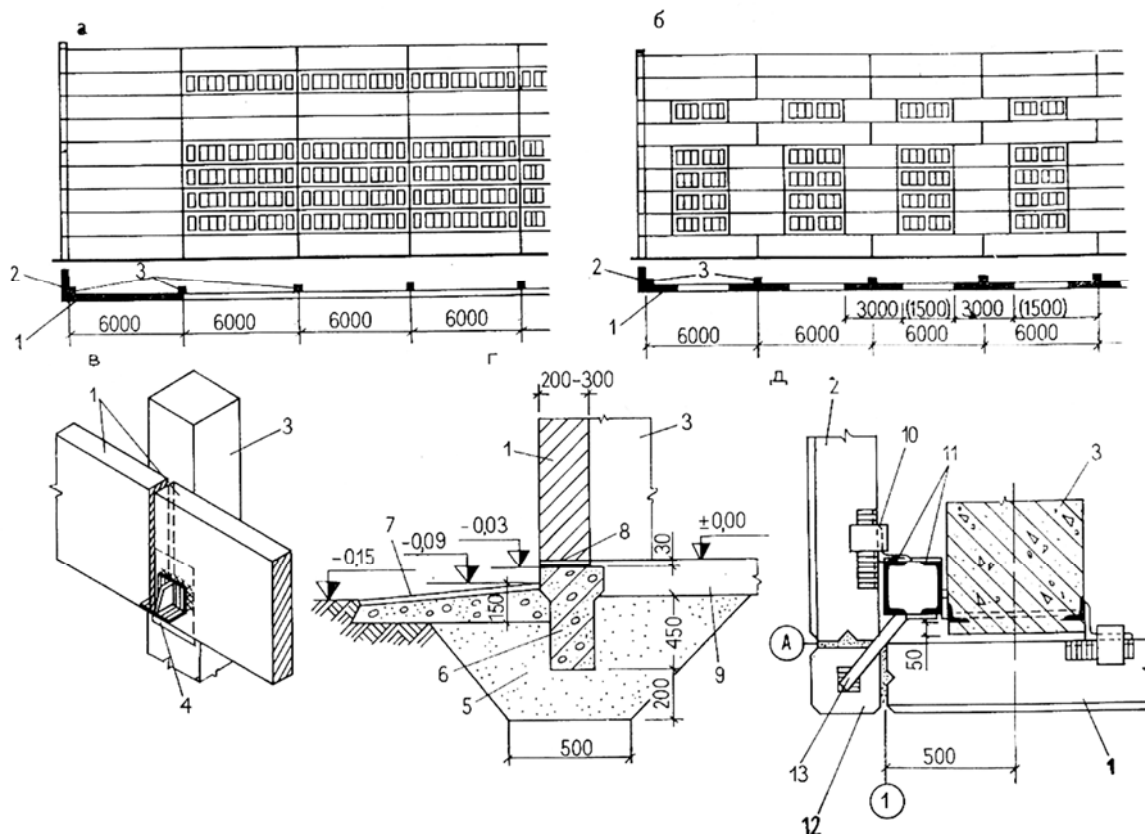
Фасады и узлы крупнопанельных стен отапливаемых зданий [38]:
